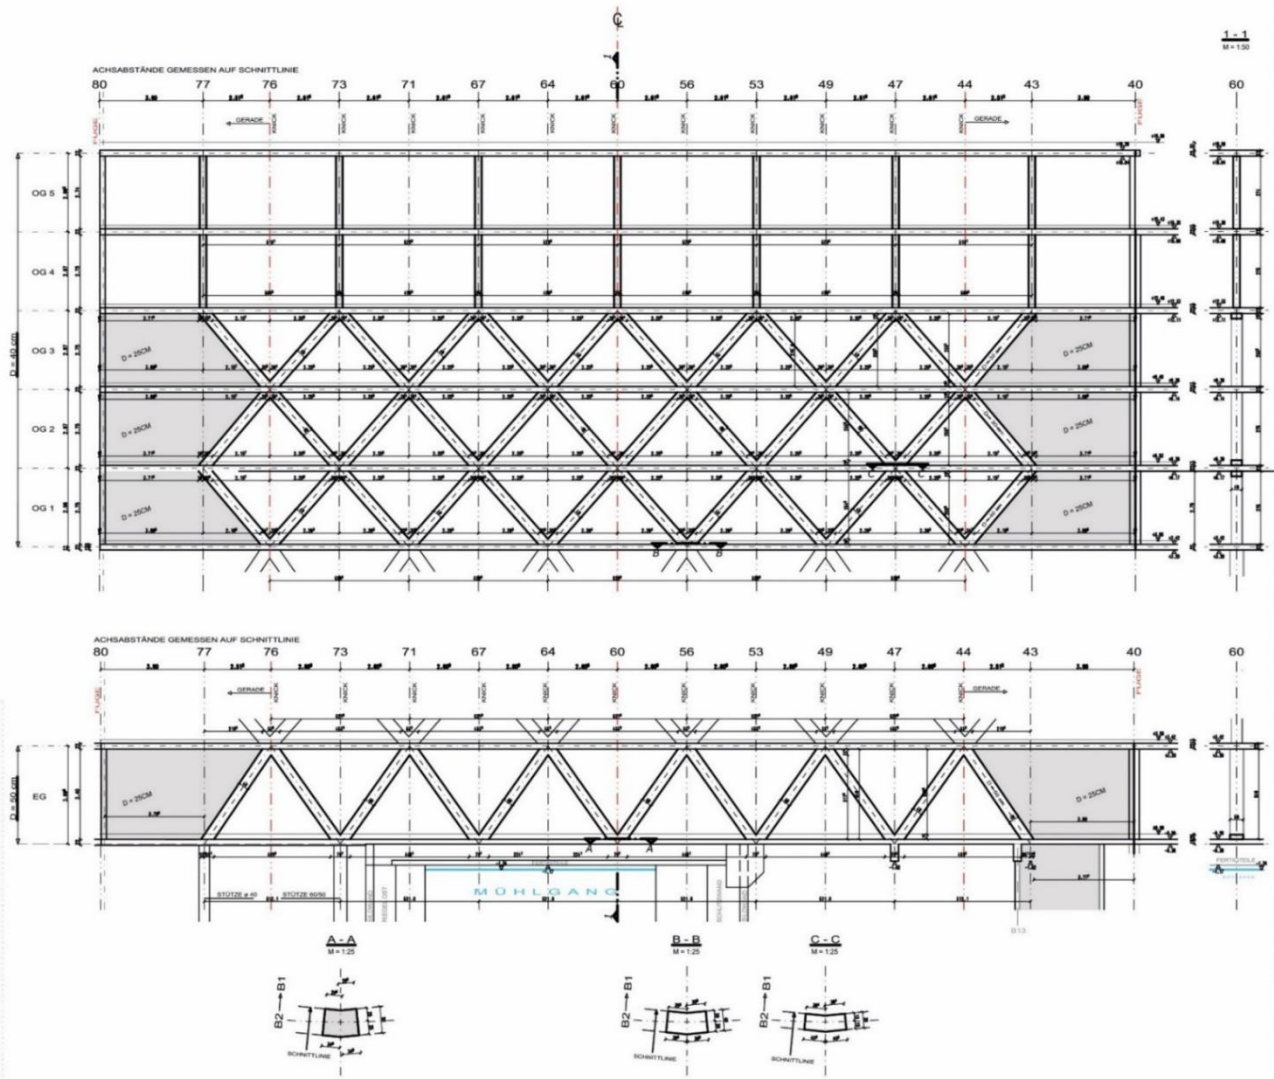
Plano de sección vertical de la estructura de la parte curva
